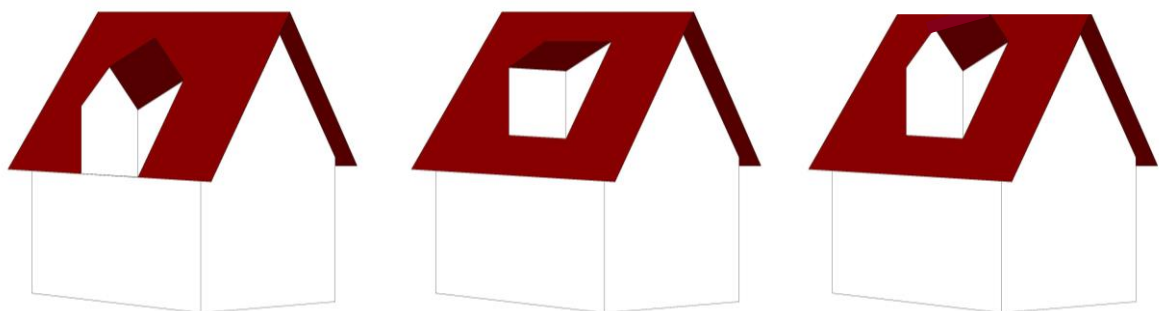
Mögliche Dachgauben: Zwerchhaus, Schleppgaube, Satteldachgaube
